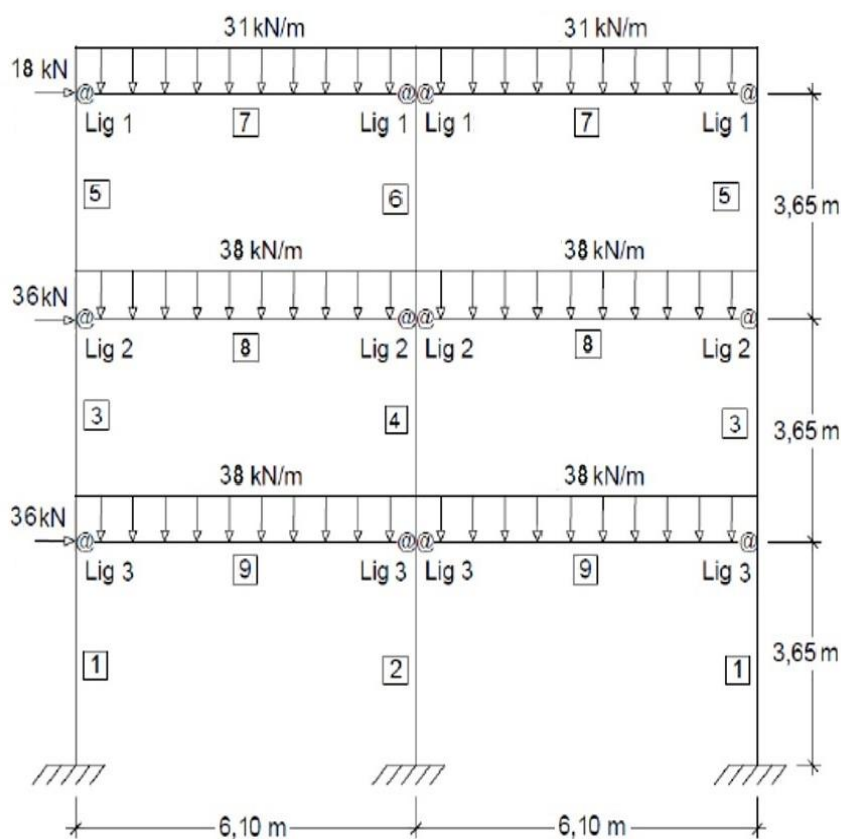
Carregamento, geometria e variáveis do terceiro pórtico.
